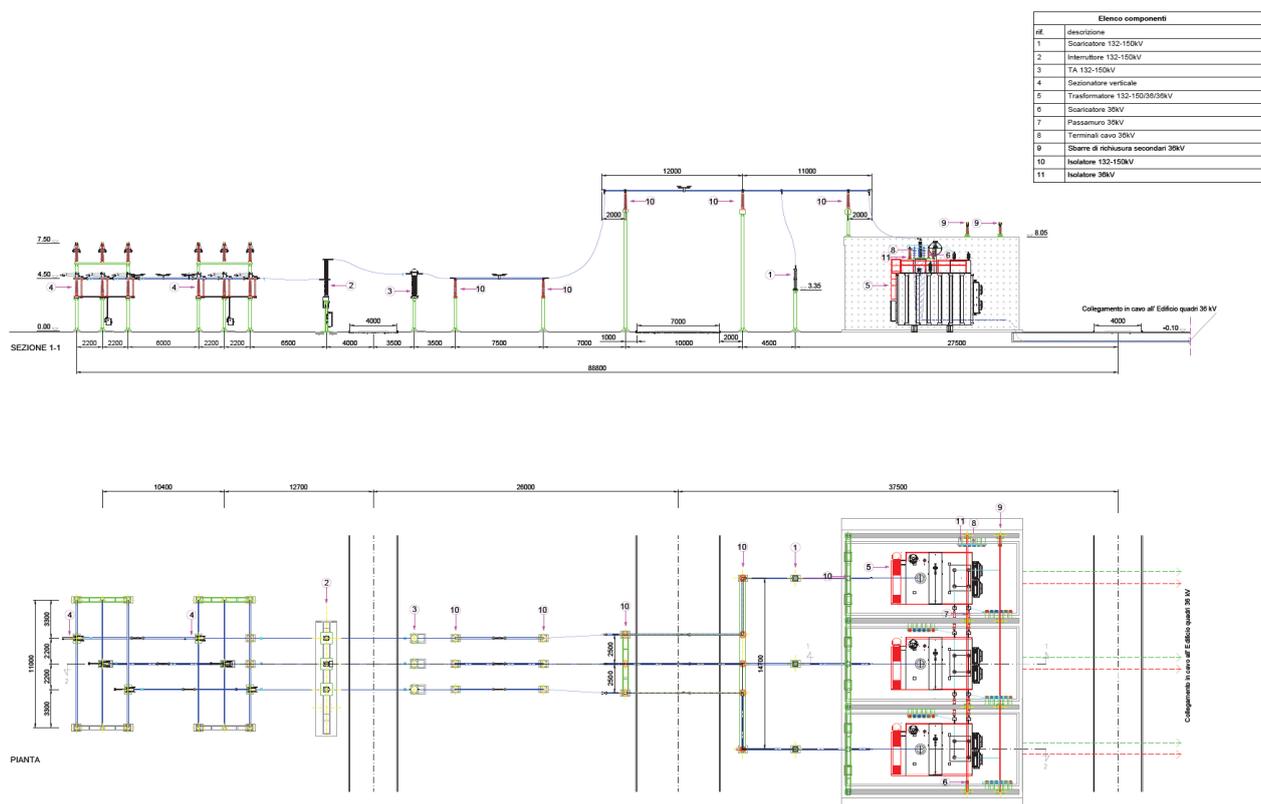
Pianta e sezione montante TR 150/36 kV – 250 MVA
